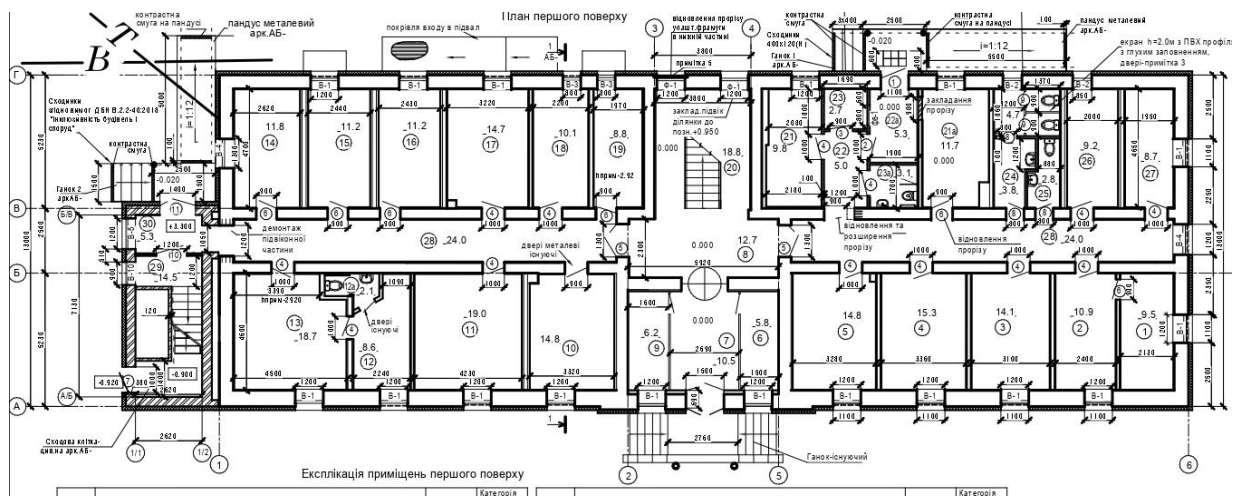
План першого (типового) поверху нежитлової будівлі
